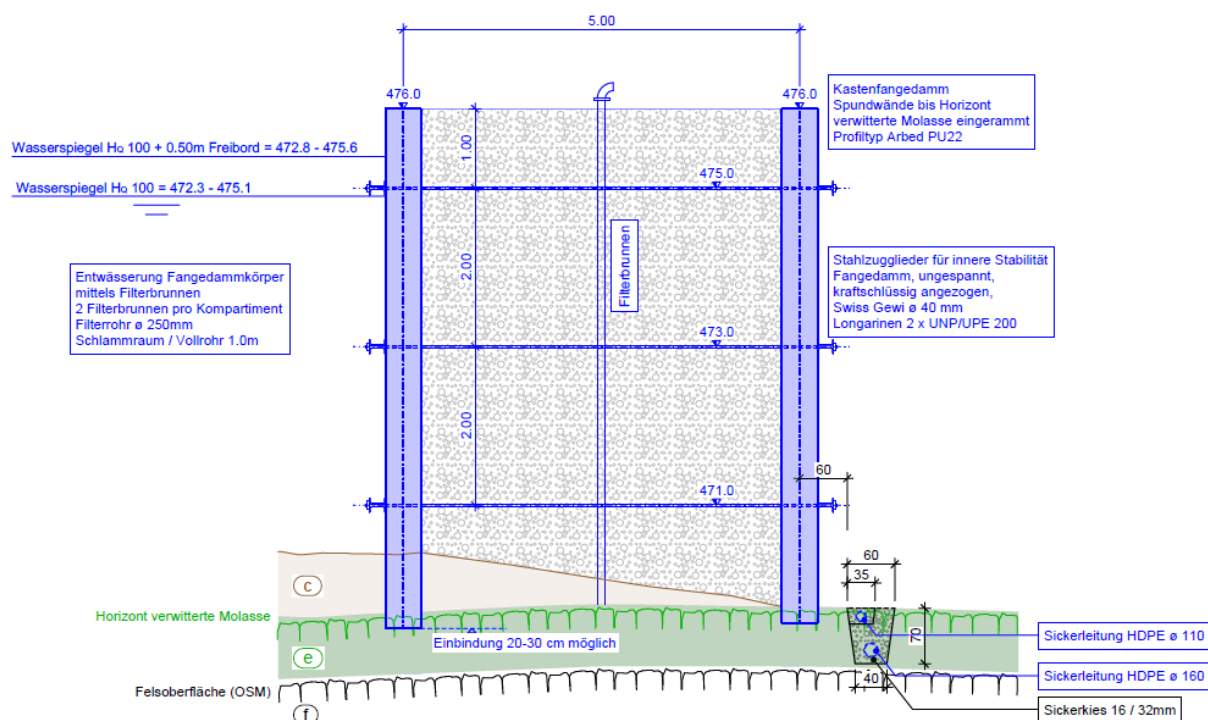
Systemschnitt Konstruktion Kastenfangedamm
